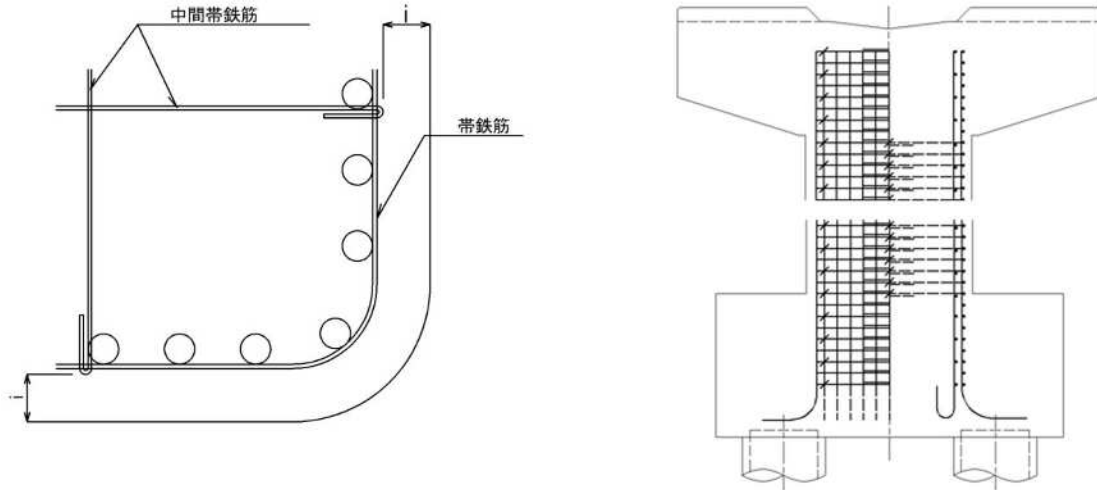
柱のかぶりと主鉄筋の定着例（要領 図-3.72）
